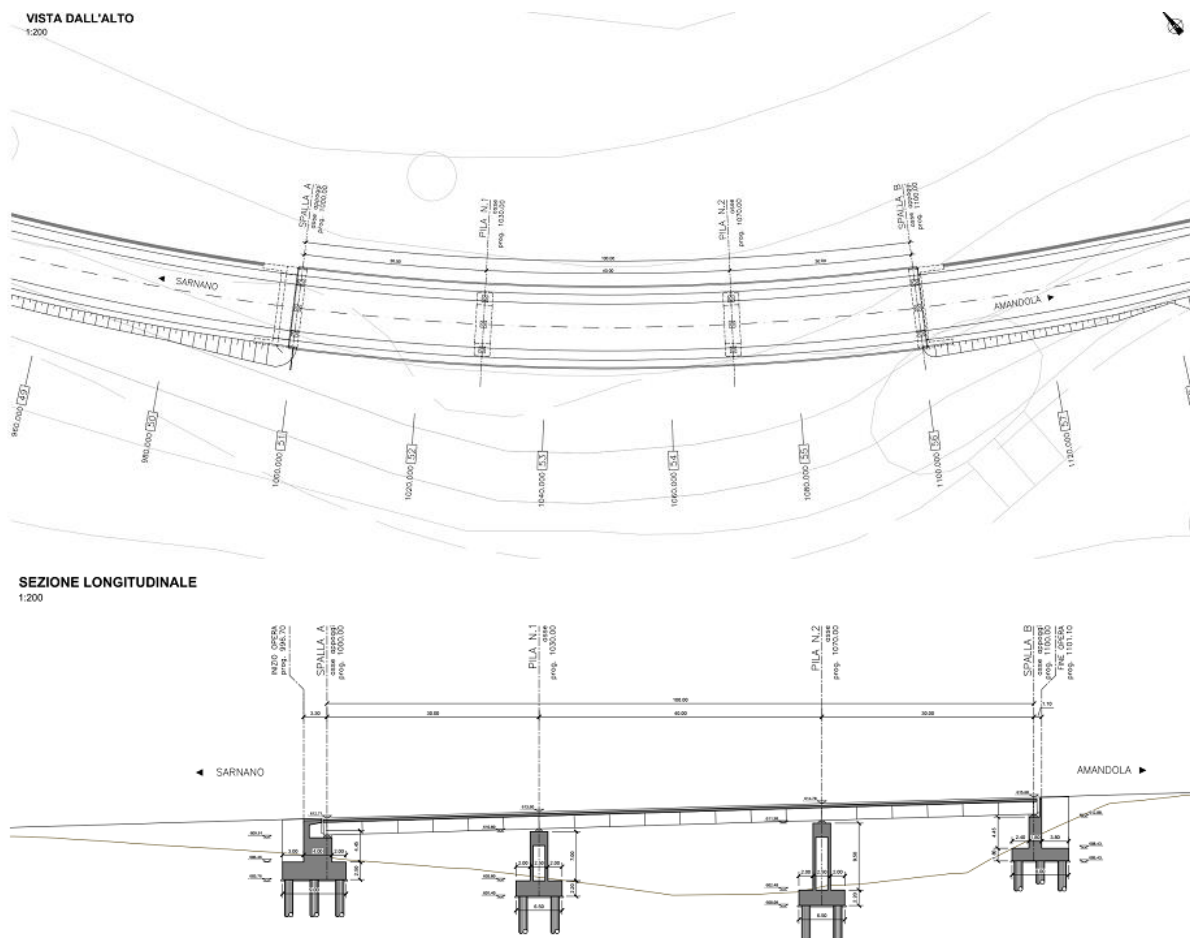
Planimetria, prospetto e sezione del Viadotto VI.01
